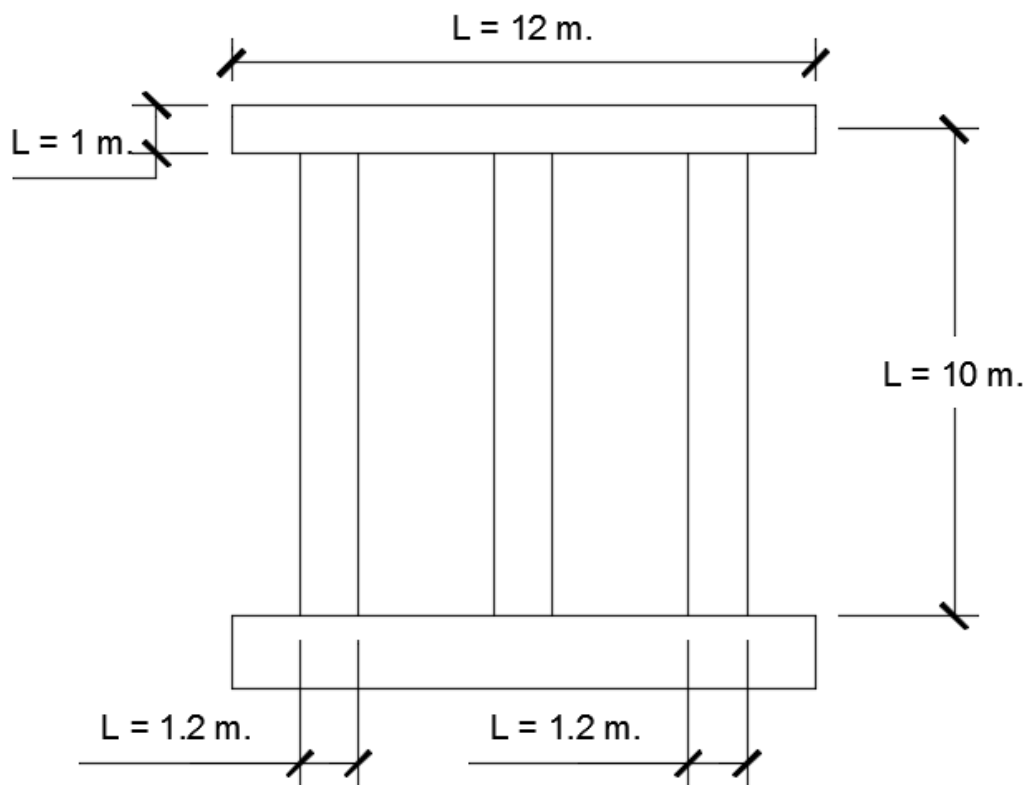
Vista en elevación de la sección del pilar 2 con su respectiva viga cabezal
